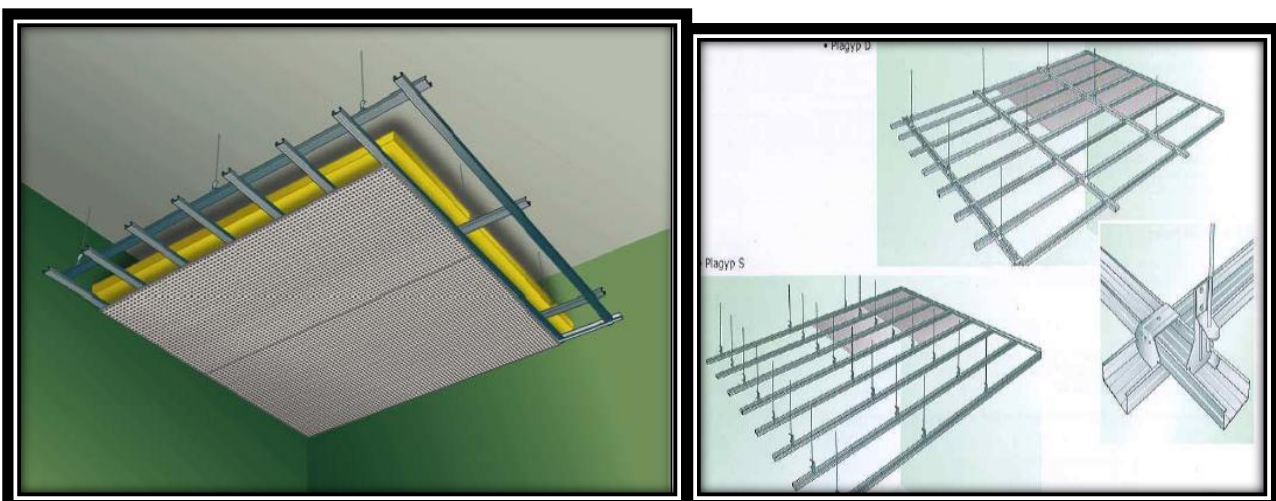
Détail du système d'accrochages des faux plafonds
